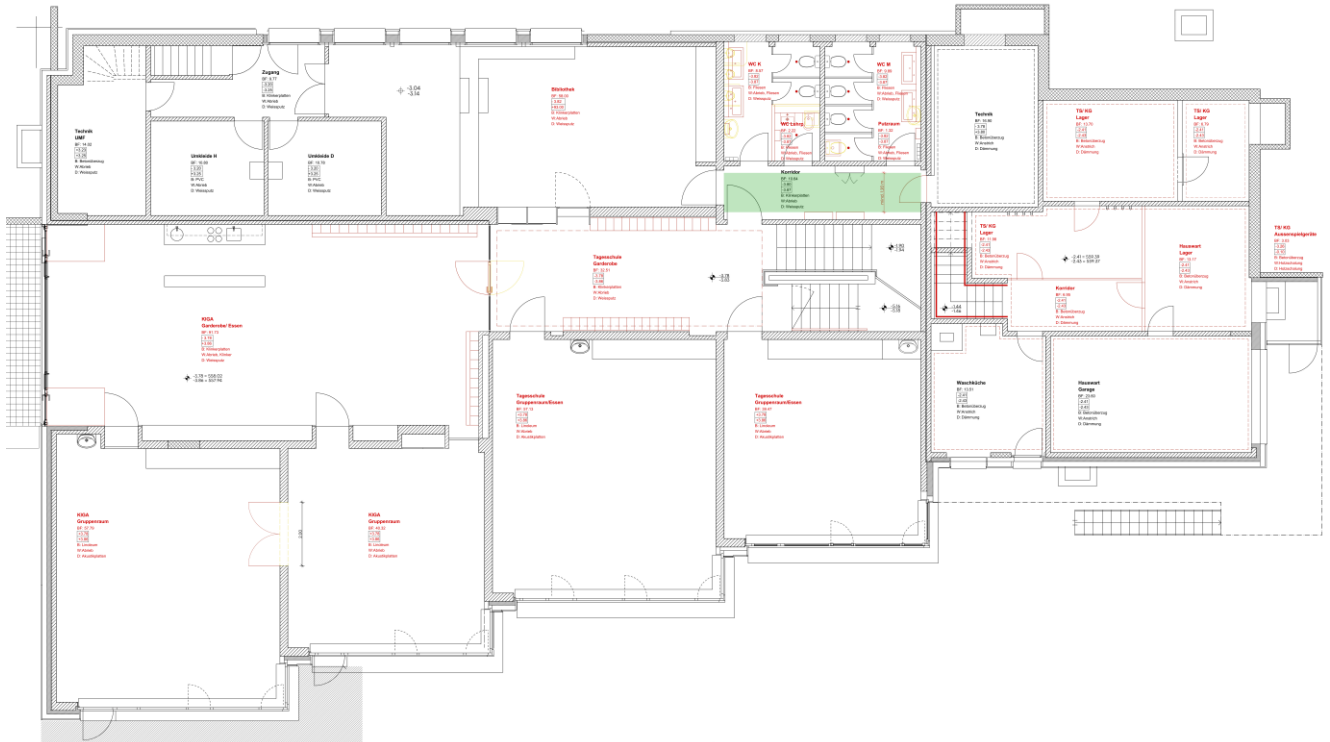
Grundriss 1. Untergeschoss, Gebäude 3
